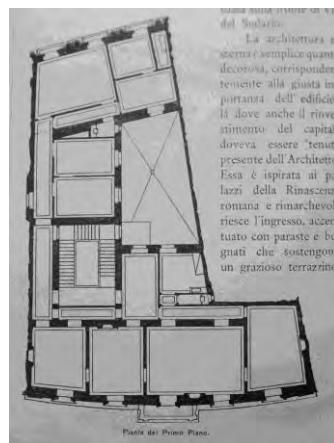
palazzo Lavaggi pianta piano primo da “L’Edilizia Moderna”, 1900
